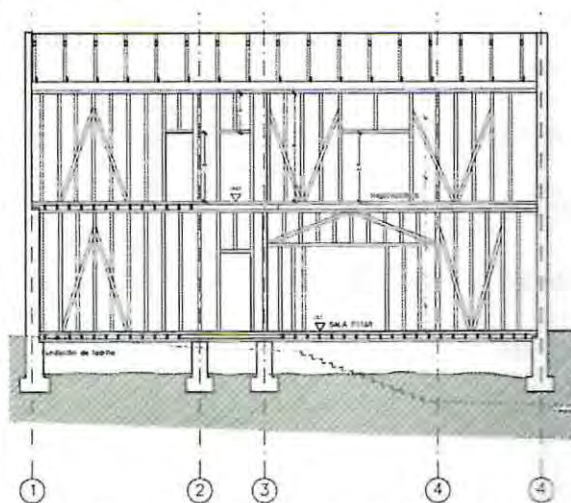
Jimenez, M. (2015) Corte longitudinal casa Dimalow 167.
